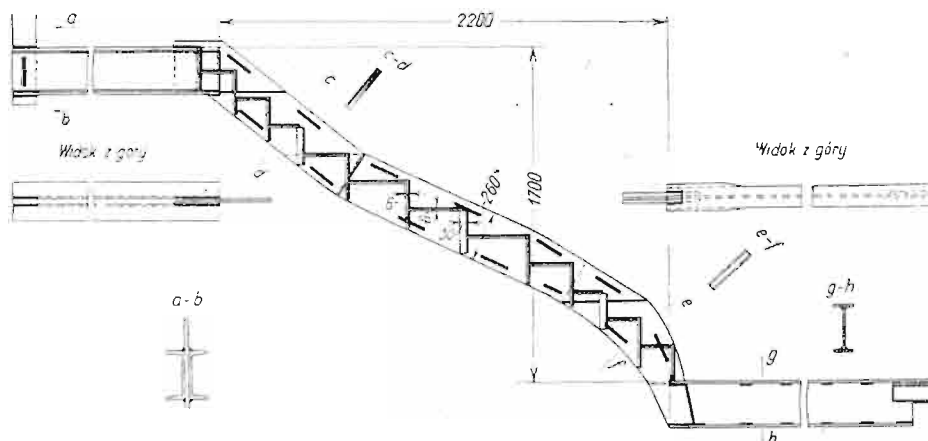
Konstrukcja schodów głównych i szczegóły przegubu B.
